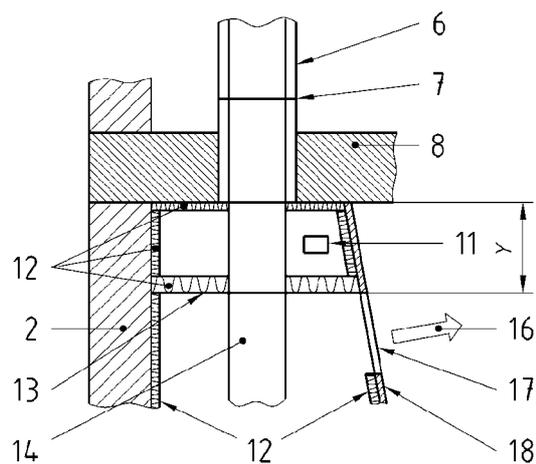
Vue de face d'un exemple en présence d'un plafond ou faux plafond réalisé avec des matériaux non combustibles + poutres bois, et adossement sur cloison intérieure
